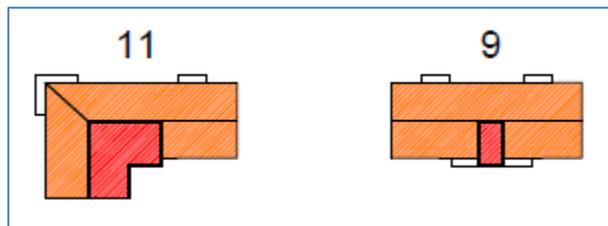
Situación de cubierta inclinada y plana en los edificios caso de estudio, vivienda en centro y vivienda en esquina.
